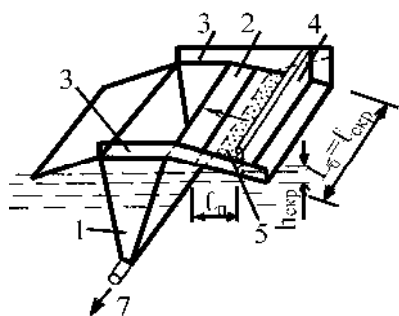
Схема приемного бункера: 1 – бункер; 2 – пандус; 3 – борт; 4 – скребок; 5 – удаляемый шлам; 6 – труба для выпуска шлама из бункера
